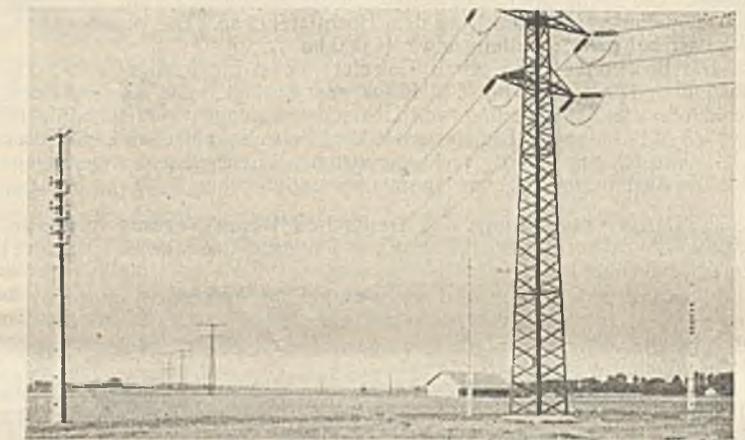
Kreuzung einer 100 000-V-Leitung, zwei Abspannmaste, 1 Tragmast. Bemerkenswert der Unterschied des schweren Eisengittermastes und des schlanken Eisenbeton-Kisse-Mastes.
